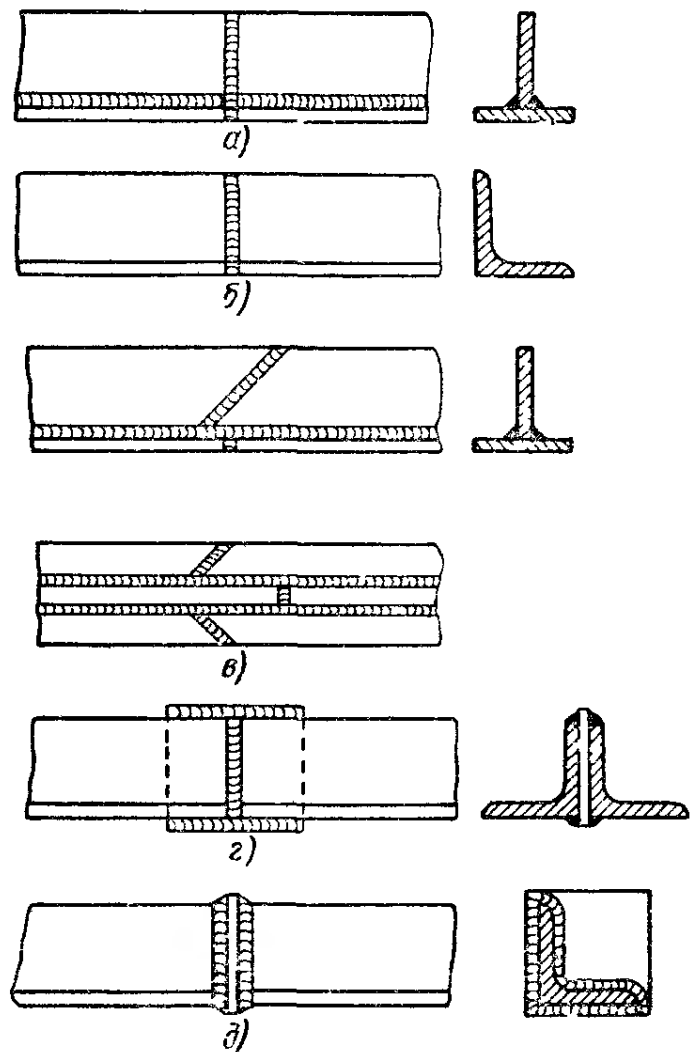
Примеры сварки стыков элементов стропильных ферм
